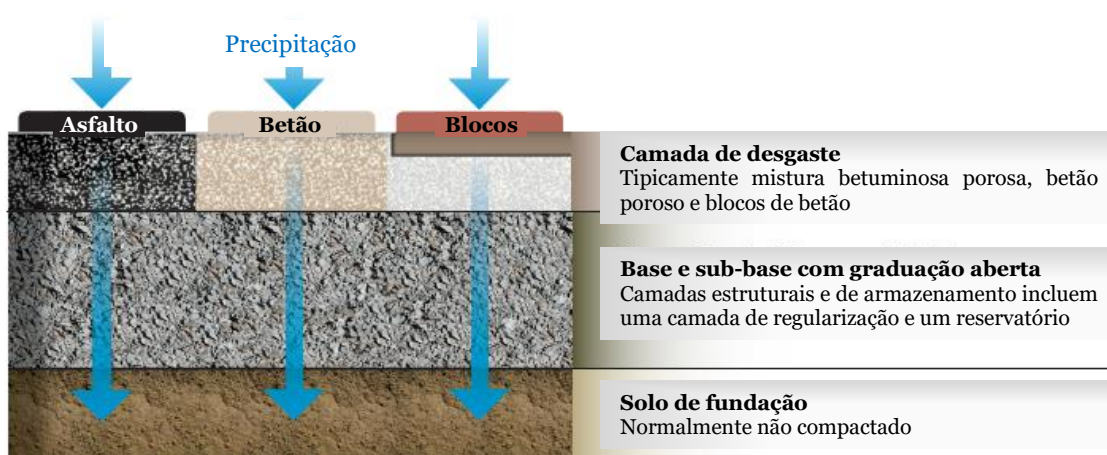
Secção típica de um pavimento permeável (Adaptado de ASCE, 2013)
